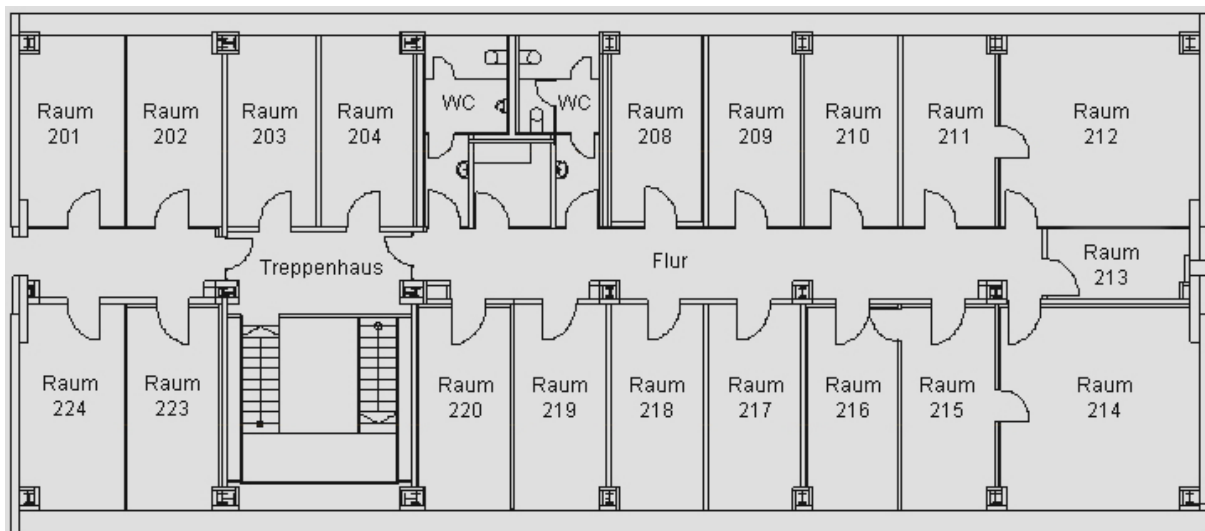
Grundriss 2. Obergeschoss
